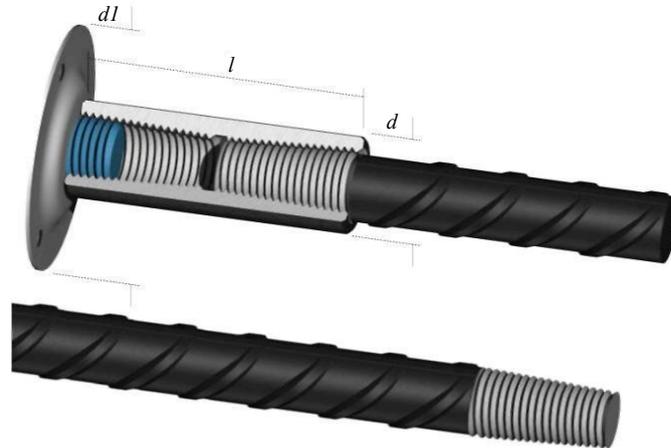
Механическое соединение с арматурным выпуском Ancon TTSB.
